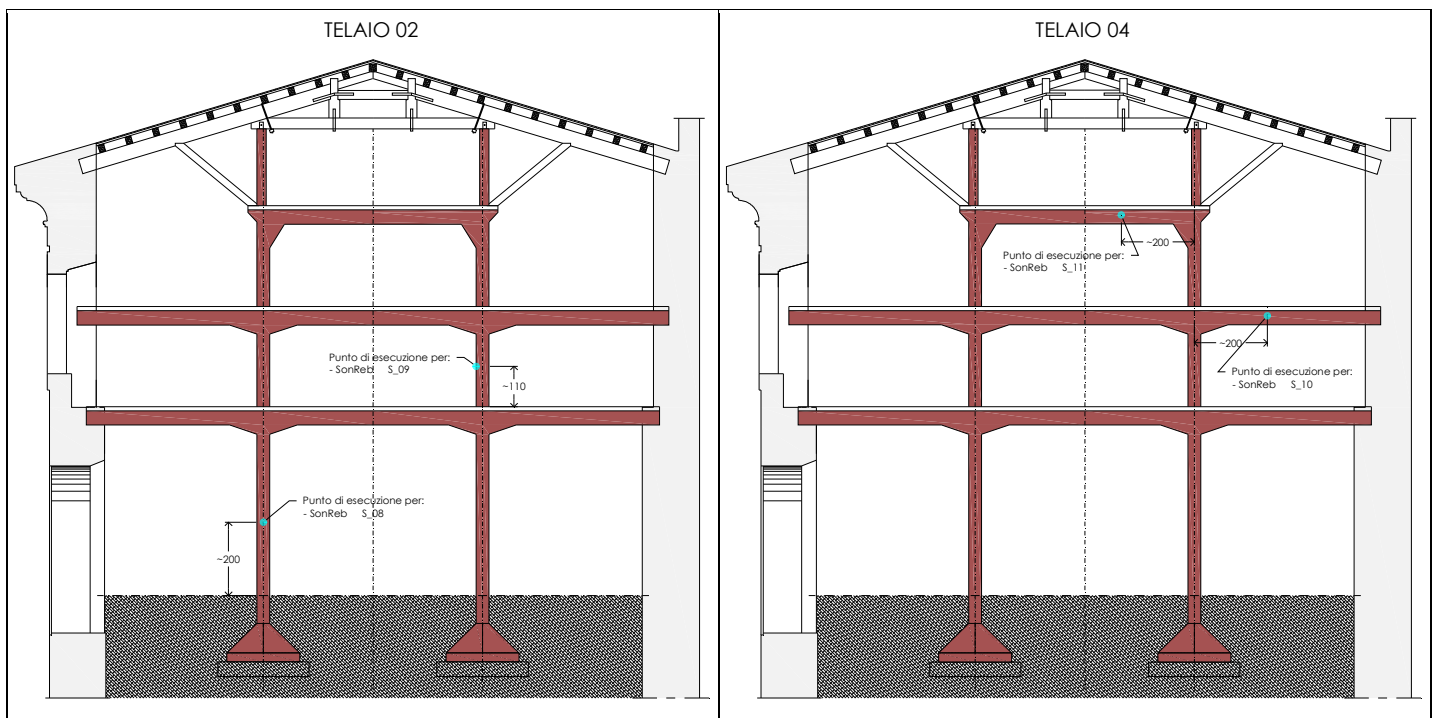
Posizione delle prove SonReb sui telai 02 e 04
